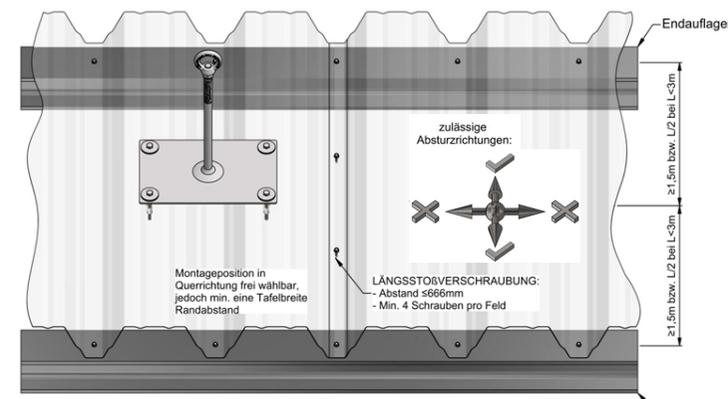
Montagevorgaben auf Trapezprofil (Positivlage) bei Absturzrichtung in Trapezprofilspannrichtung
